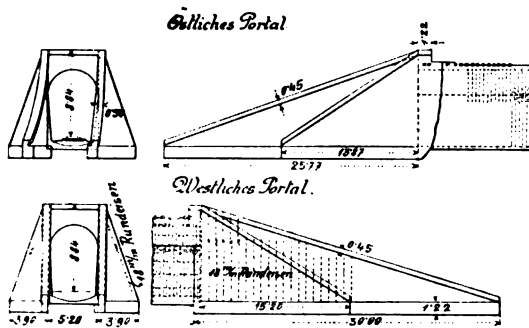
Flügelmauern des Kicking Horse River-Tunnels.
